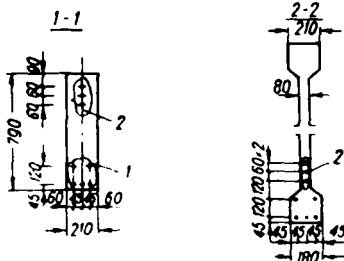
Конструкция балки пролетом 12 м с отогнутой прядевой арматурой
